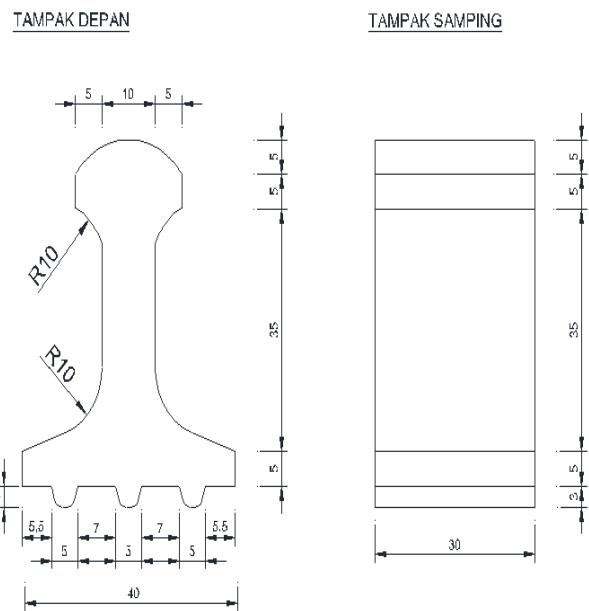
Modul Dinding atau Lantai Tipe-T Beton Pracetak Modular
